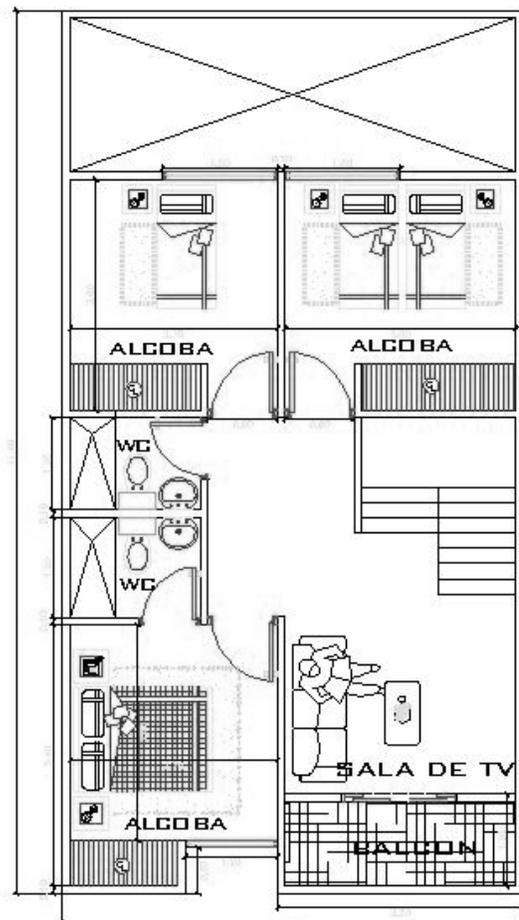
Plano Arquitectónico Vivienda Ciudadela Risaralda
